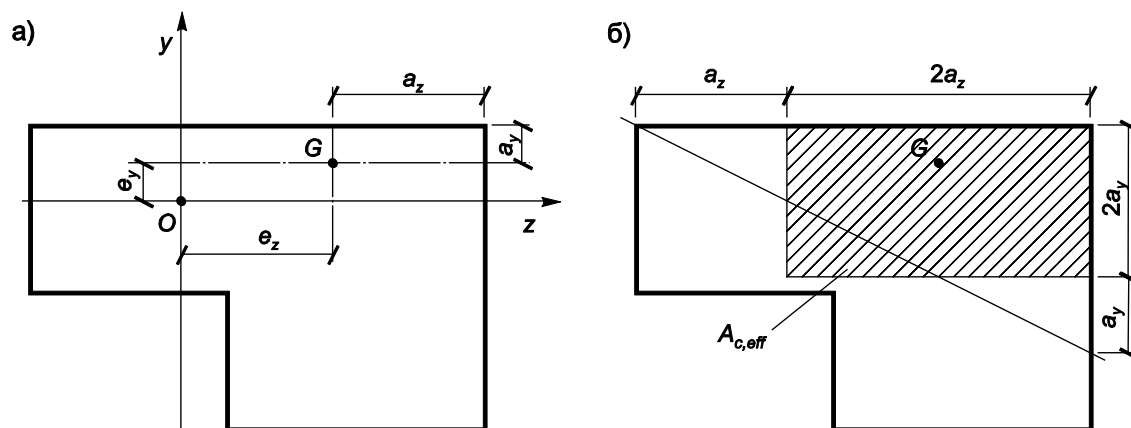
Эффективная площадь поперечного сечения бетонных элементов при расчете на косое внецентренное сжатие
